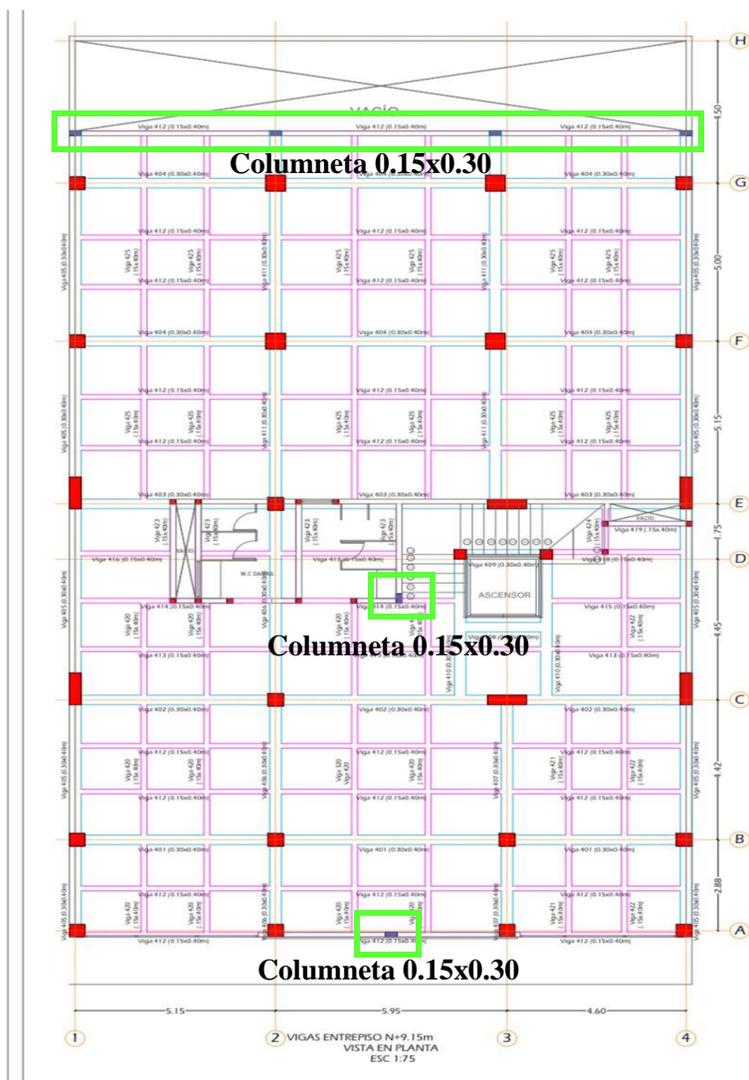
Vigas, y columnas y columnetas vista en planta.
